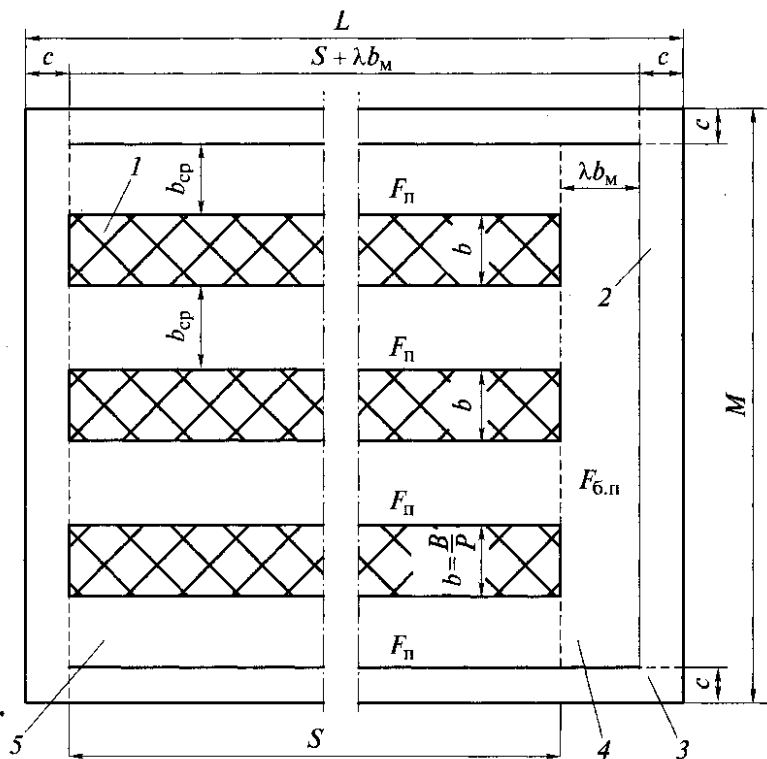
Схема к расчету площади зоны хранения техники на открытых площадках:
